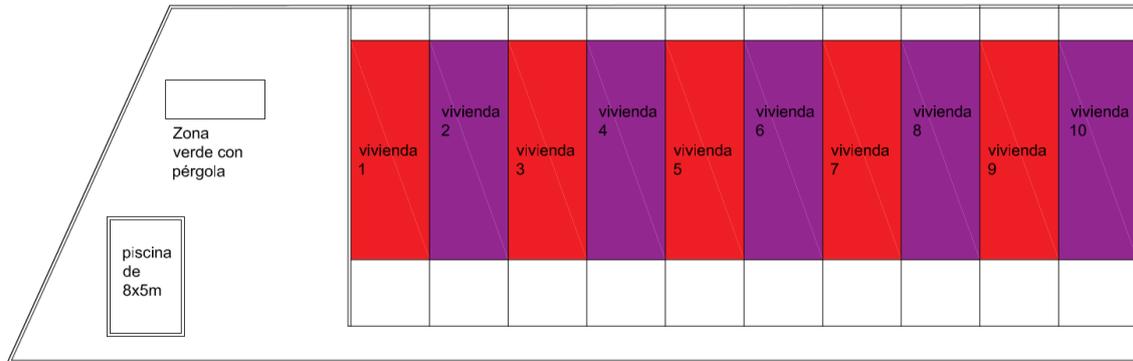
Planta baja de la promoción sin garaje. Fuente: elaboración propia
